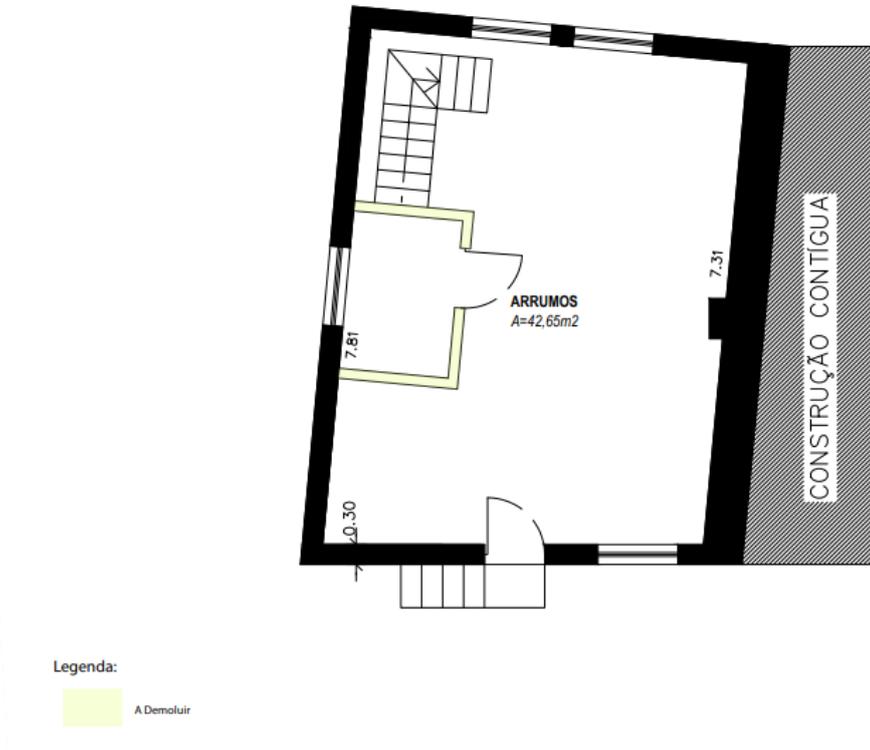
Planta de alteração. Fonte: Maria Leonor.
